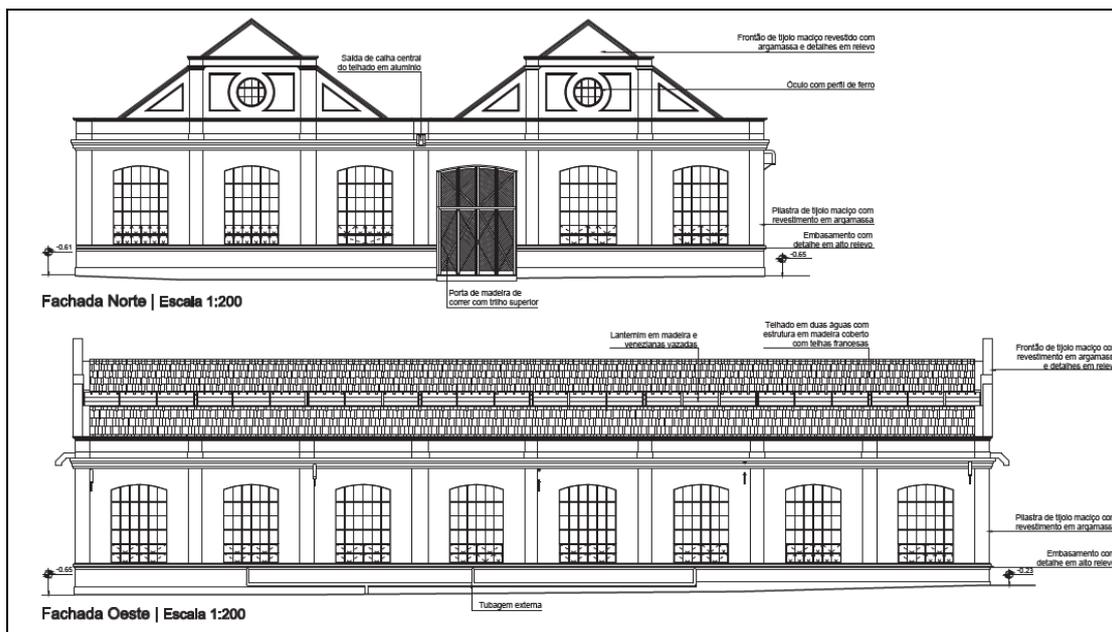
Levantamento cadastral das fachadas Norte e Oeste do Museu do Trem.
